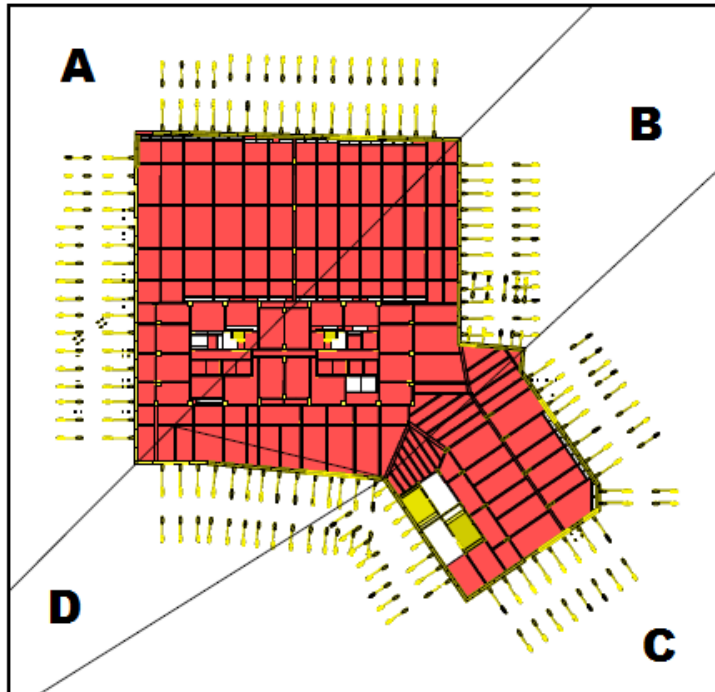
Planta tipo do Subsolo do Edifício do caso de estudo
